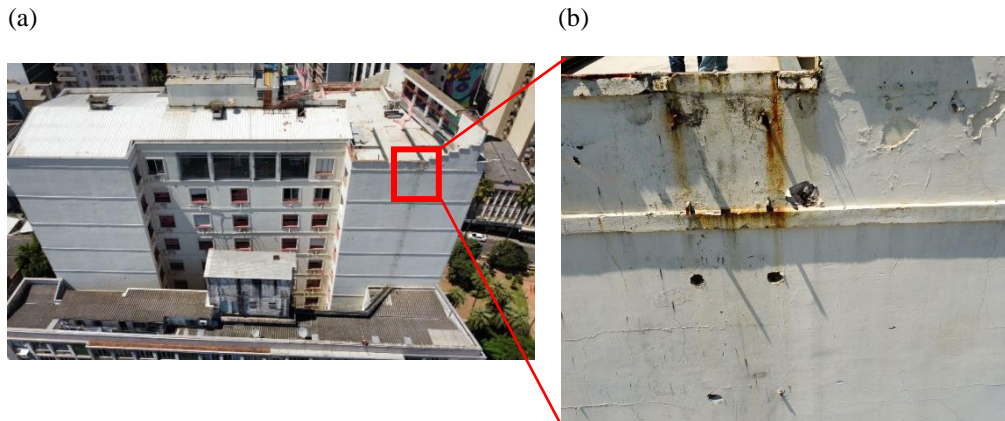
(a) localização e (b) inspeção de fissura entre esquadrias existentes no 12º pavimento.
